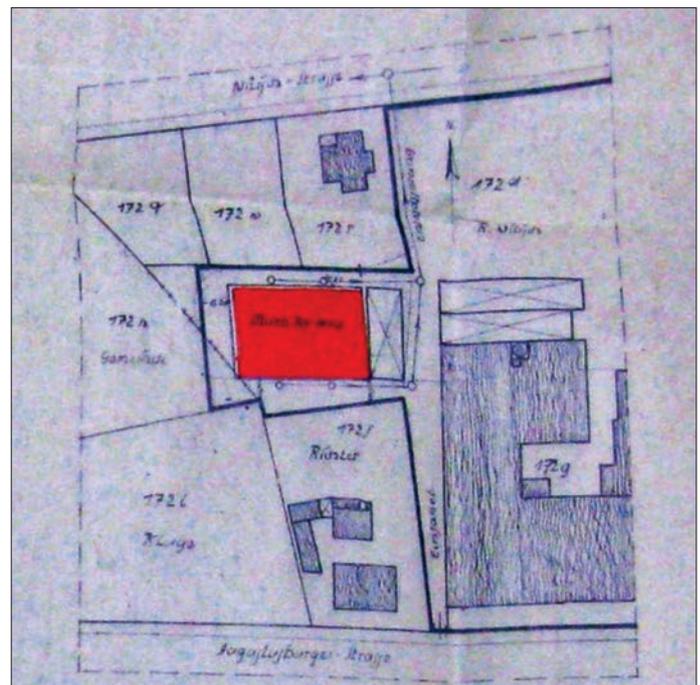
Lagergebäude, zunächst nur mit Keller- und Erdgeschoss⁵⁾
